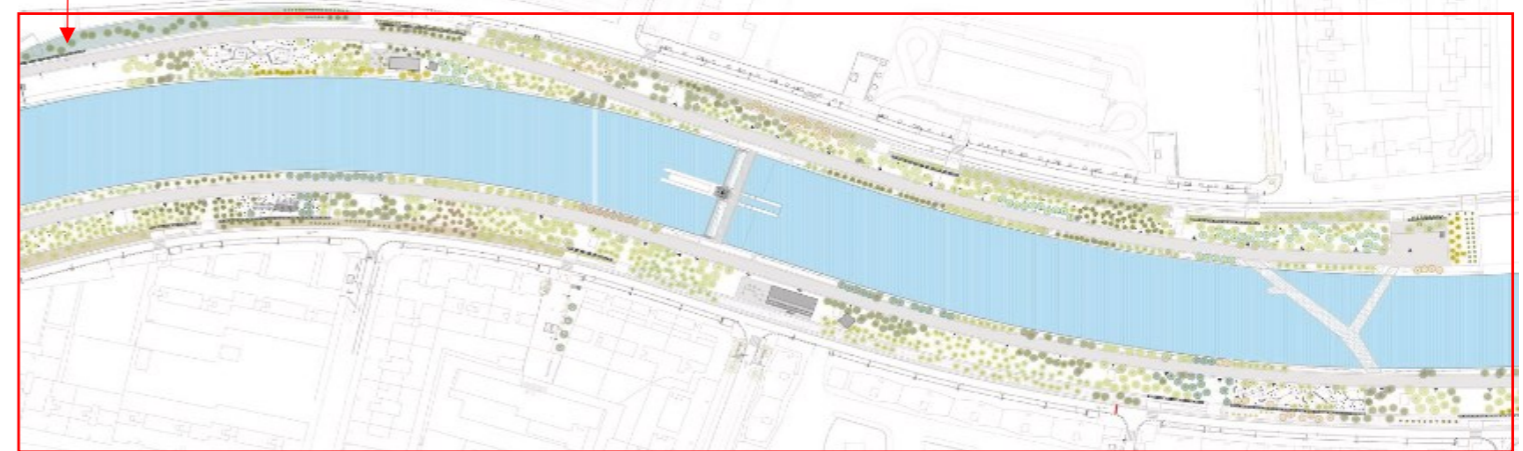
Margens do Rio Manzanares, pormenor do Plano Madrid Rio
